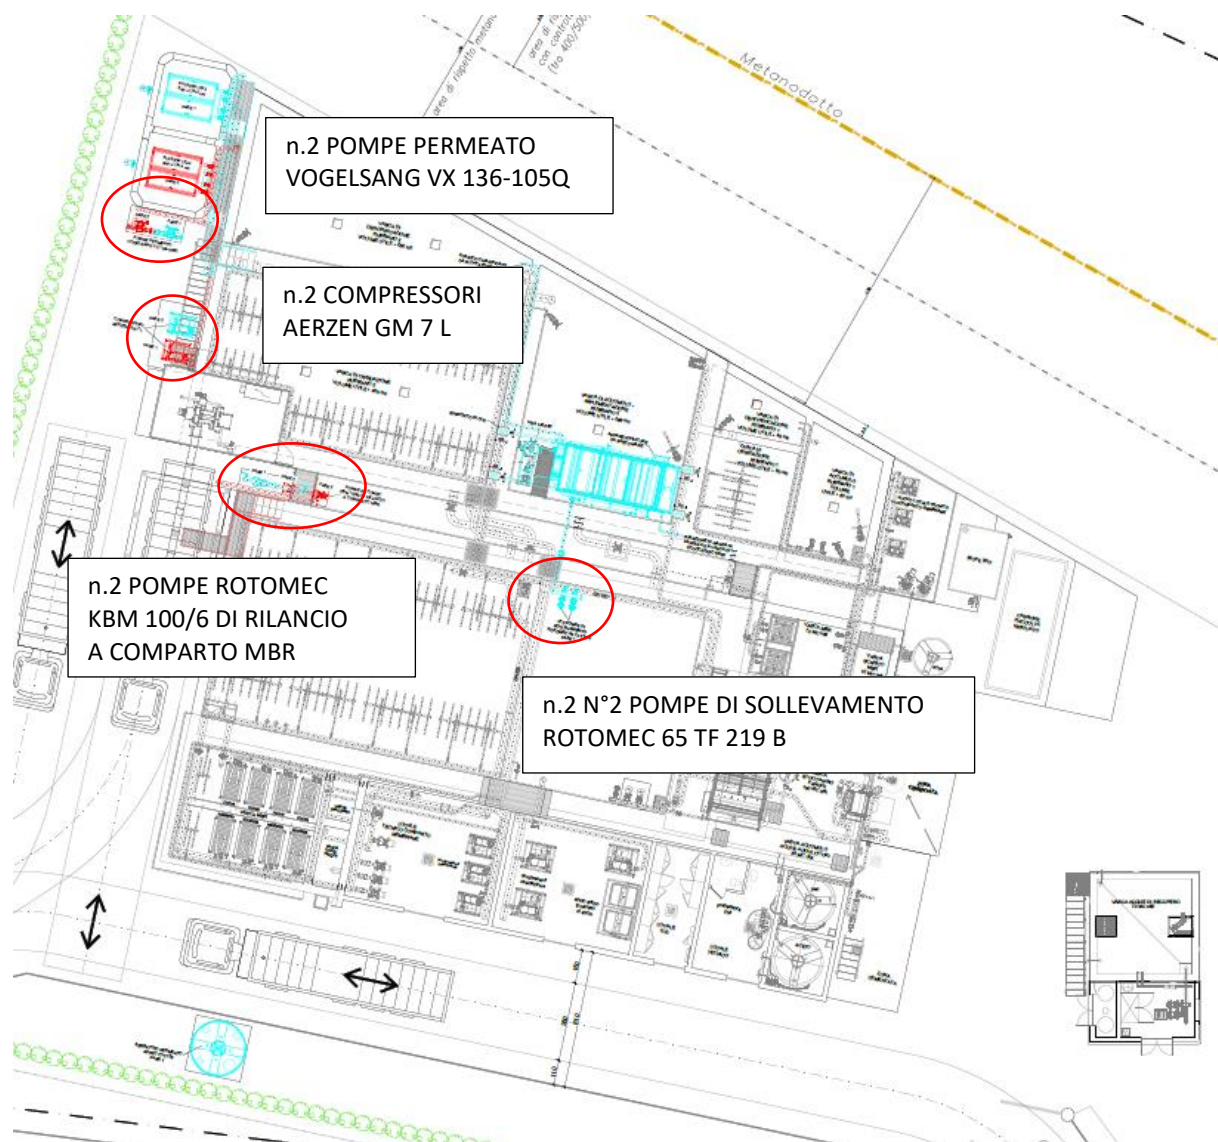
Localizzazione delle sezioni d'impianto oggetto di modifica
